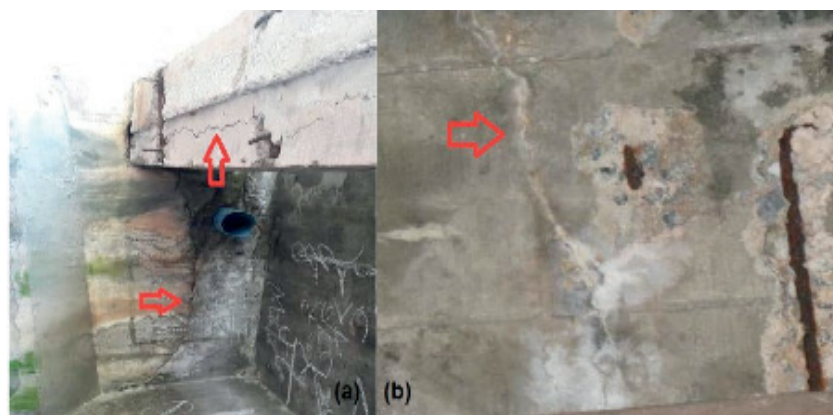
Fissuras em vigas e no tabuleiro da ponte.
